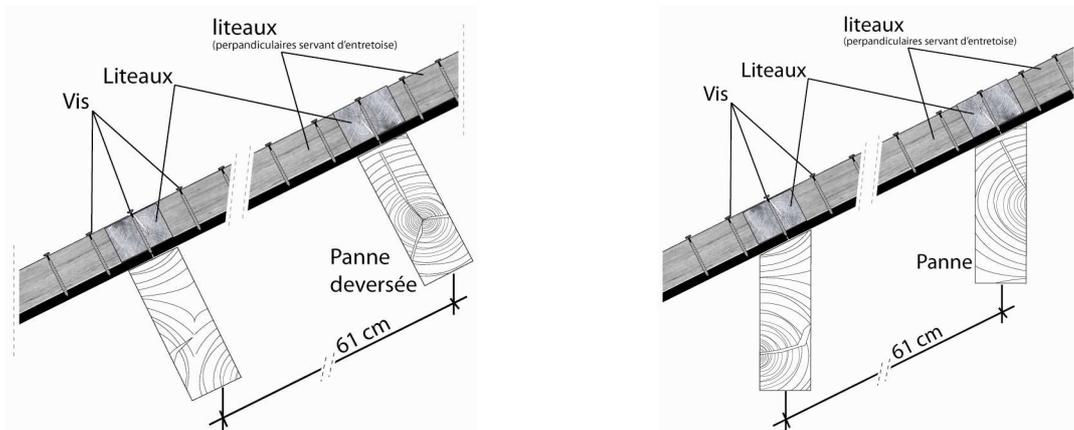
Diaphragme horizontal en toiture par voiles travaillant sur charpente avec pannes
